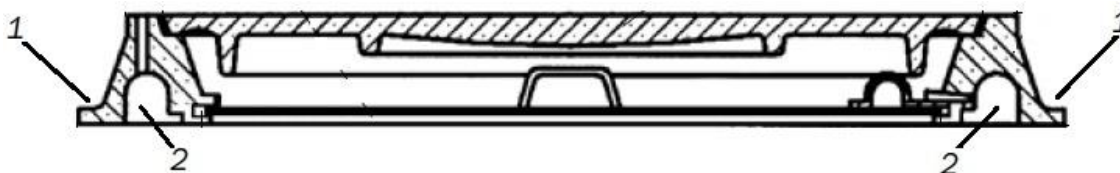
Детали корпуса чугунного люка лёгкого типа:
